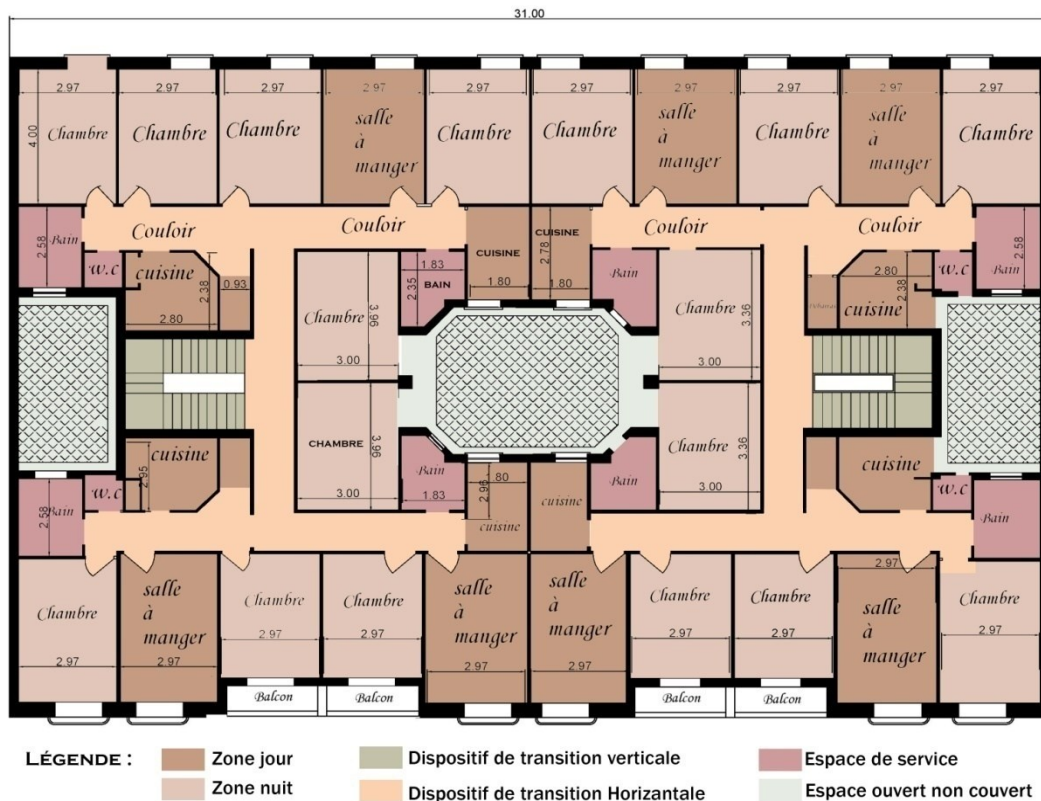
32-34 rue d'Arles, plan de l'étage.
